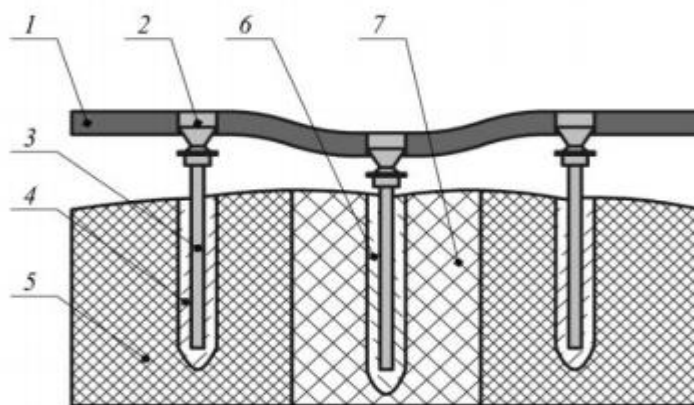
Схема осадки свай основания надземного нефтепровода:
